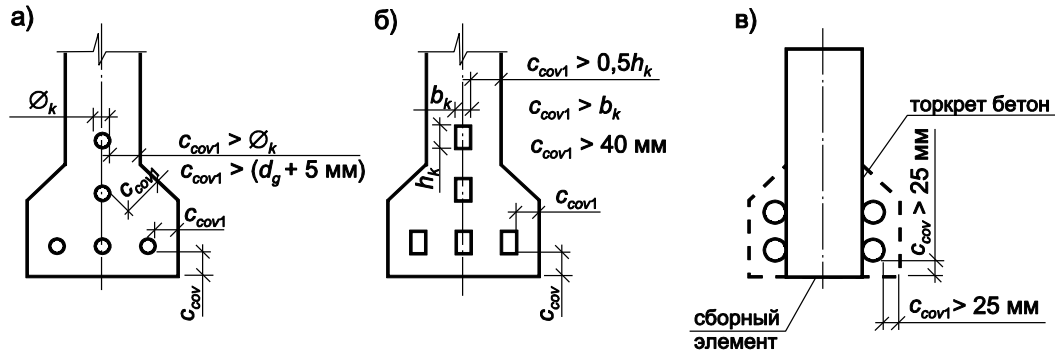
Расположение напрягаемых элементов в сечении при натяжении на бетон
